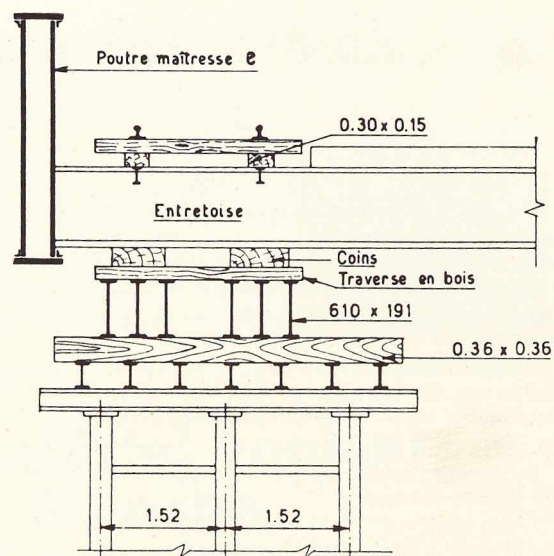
Coupe transversale montrant la poutre maîtresse et les chevalets supportant les entretoises.
